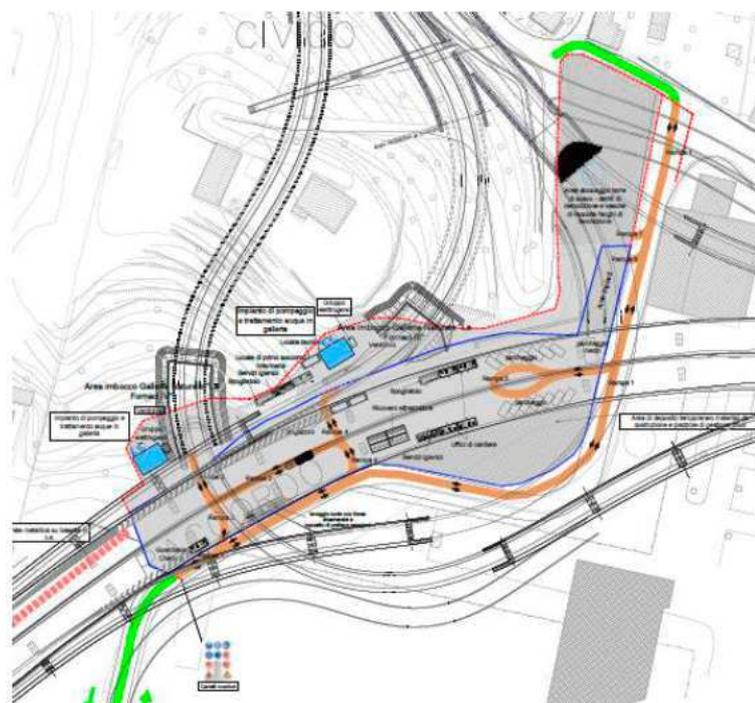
Planimetria del Cantiere Operativo Melara
